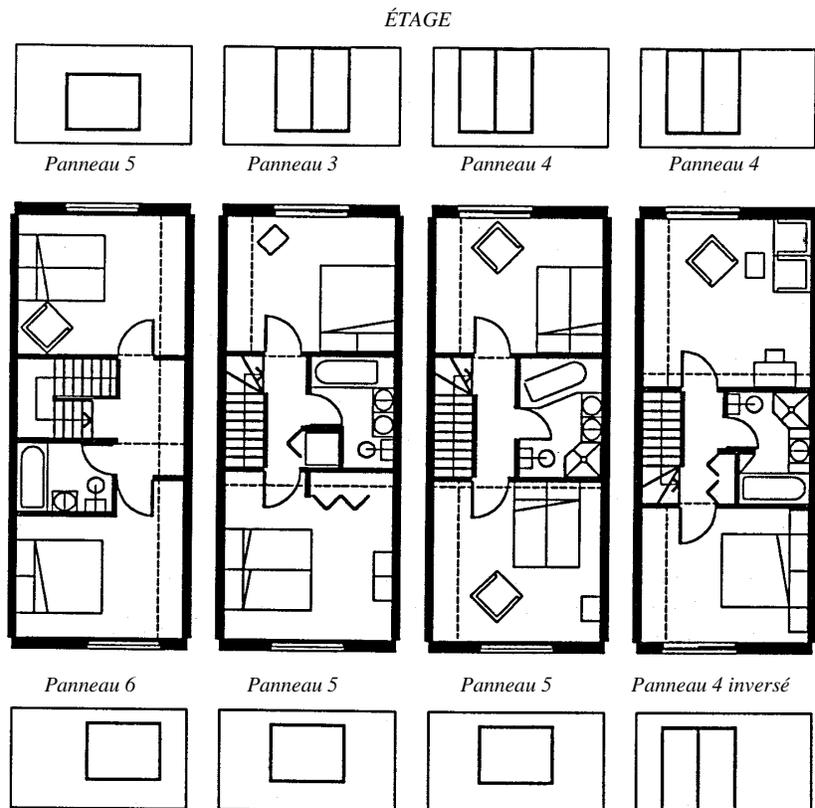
Exemples d'aménagement du rez-de-chaussée et de l'étage à partir des panneaux muraux extérieurs standards avant et arrière (Friedman et Cammalleri, 1994, p. 48-49).
